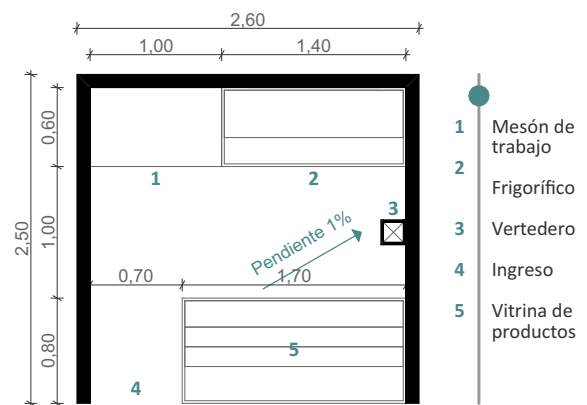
Planta de lácteos. Fuente: Autores.
